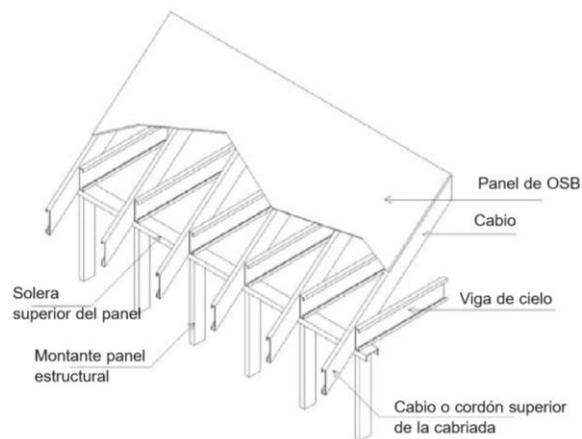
Cabios y vigas alineados con los montantes del panel estructural.
